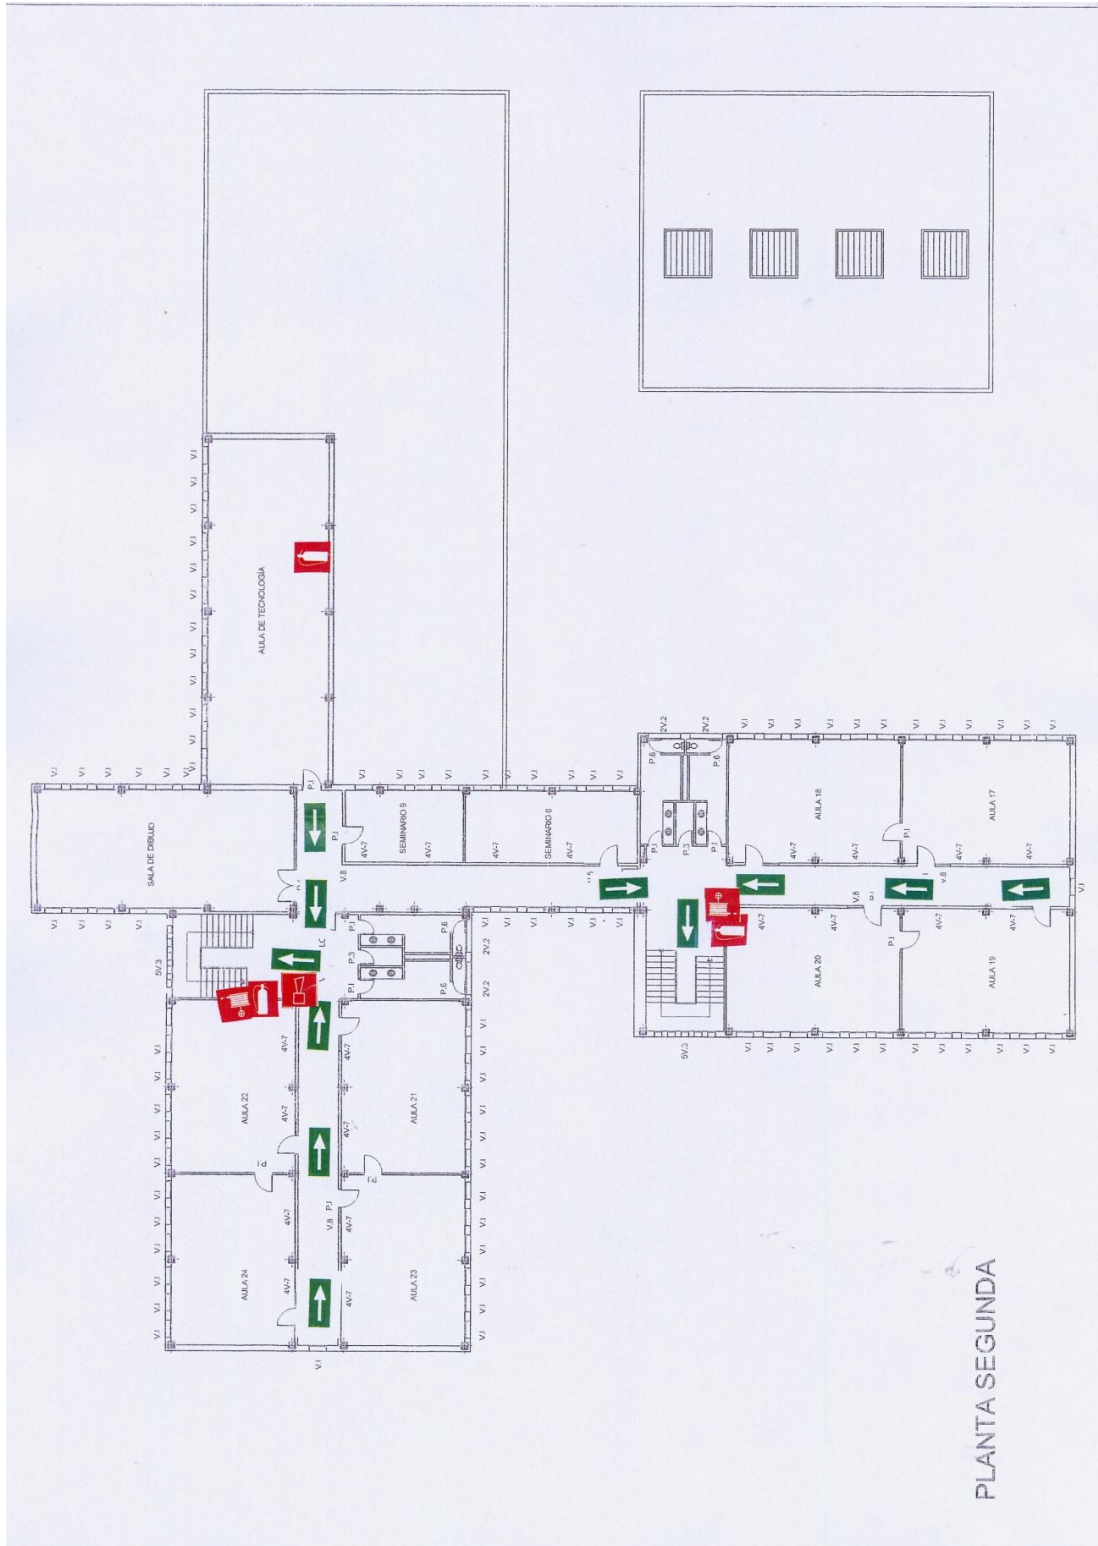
Plano evacuación planta segunda. Fuente: I.E.S Cesar Manrique.
